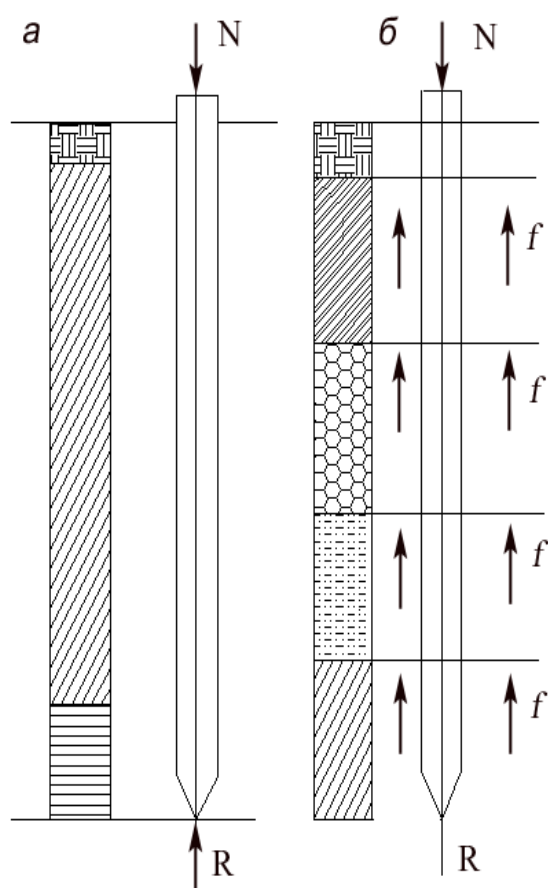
Схема работы свай в грунте: а – свая-стойка; б – свая трения
